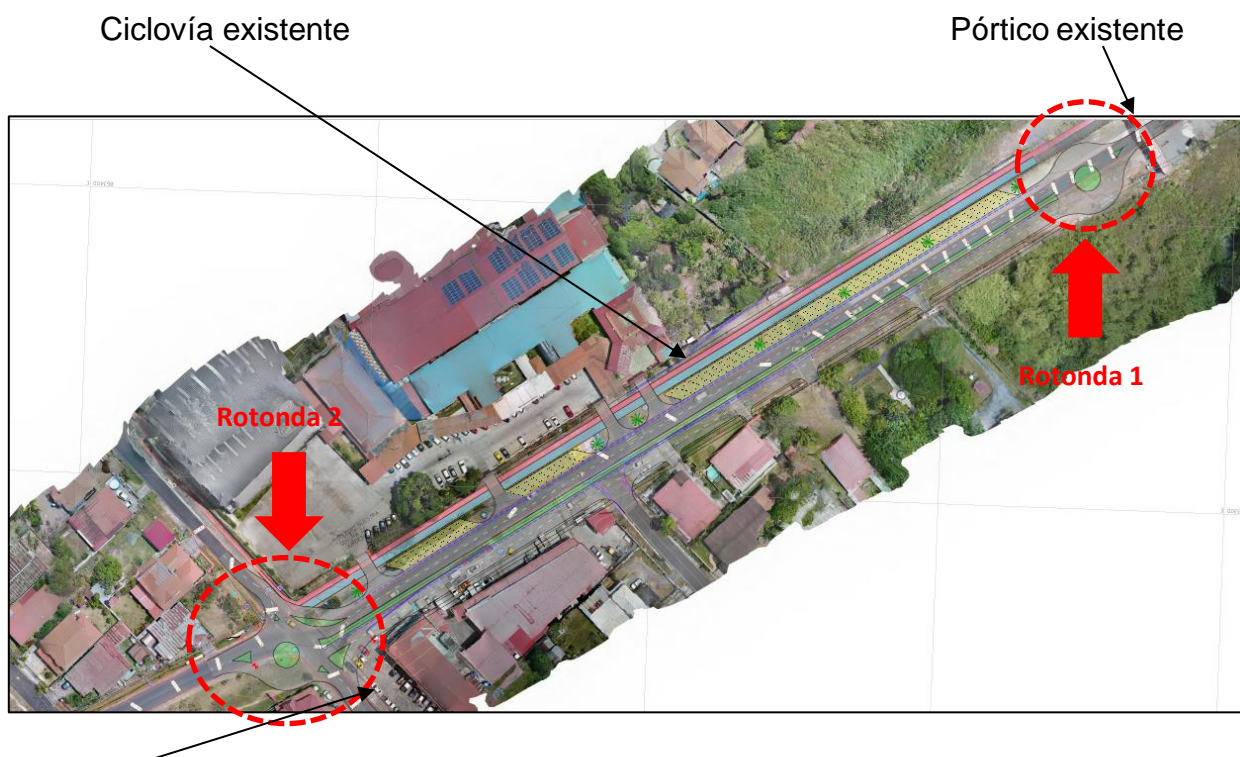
Sección de Ampliación propuesta en el tramo de la Calle Juan Meloni.
